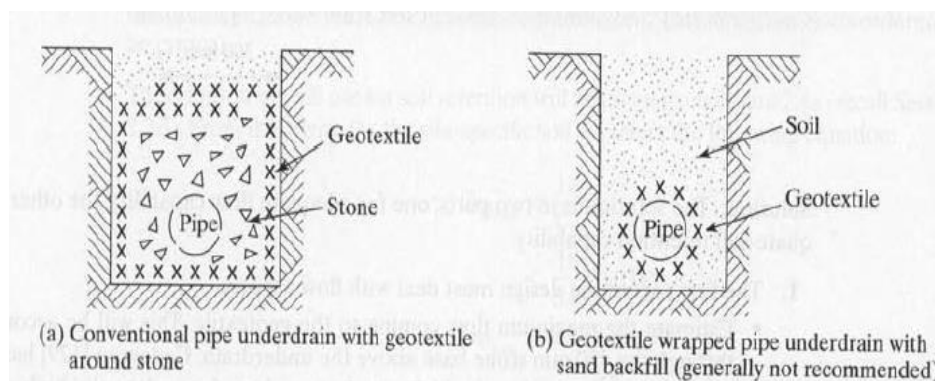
Geotextiles envueltos en tuberías de drenaje
